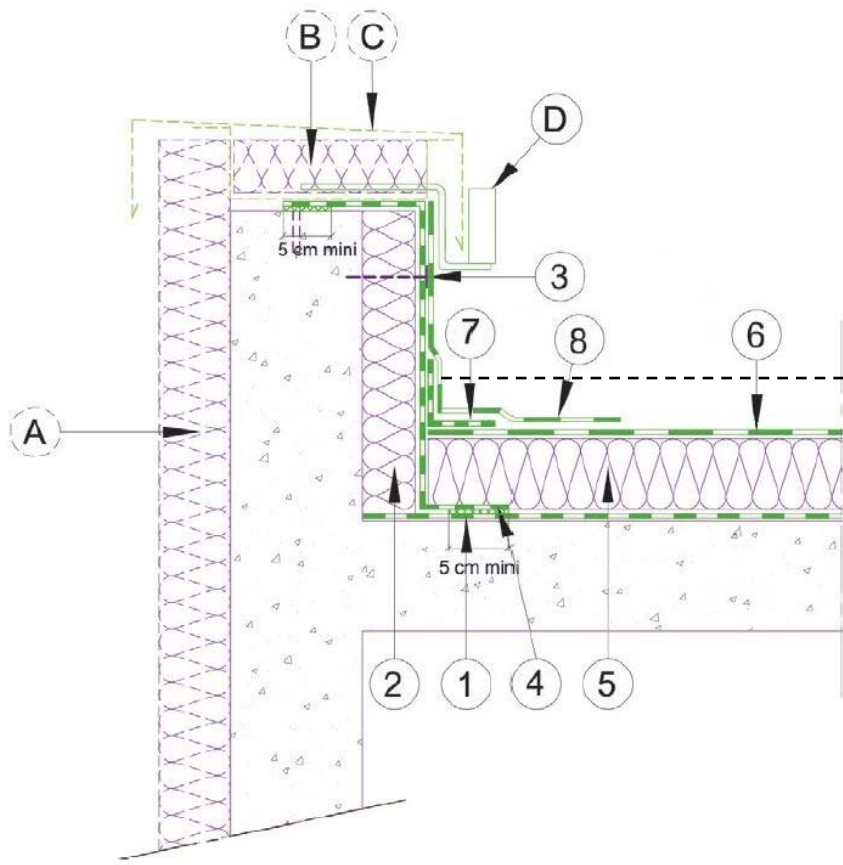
Terrasse sous dalles sur plots dont le niveau fini des dalles est au dessous du niveau des relevés
